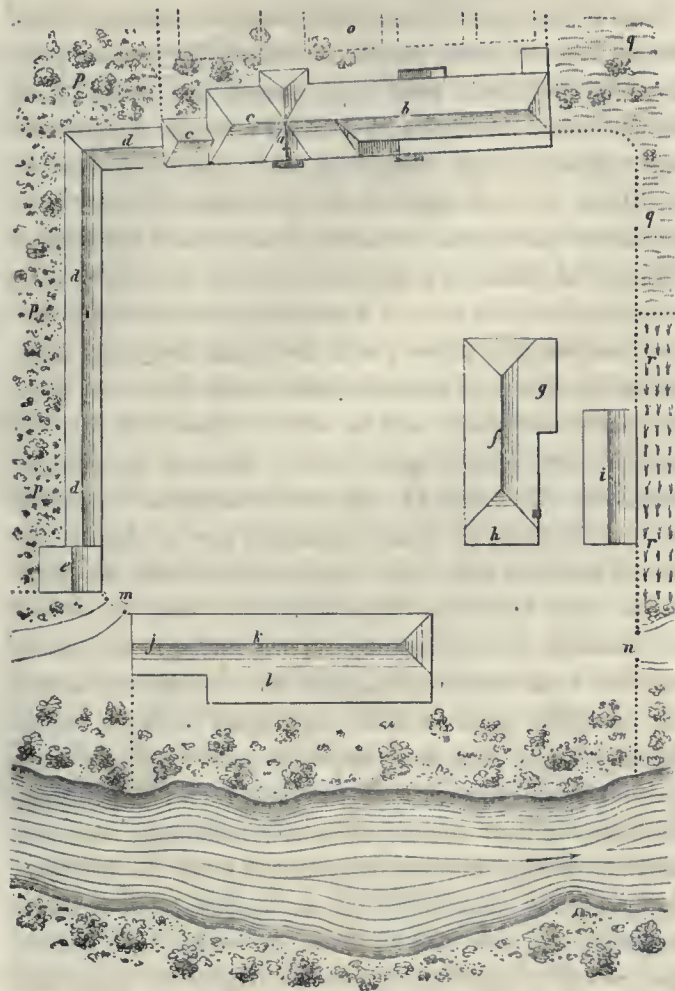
Plan général d'un Engenho (fabrique de sucre).
